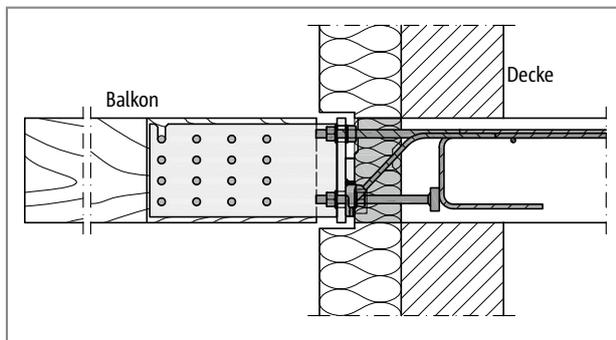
Schöck Isokorb® T Typ SK mit Stahlschwert: Anschluss an die Stahlbetondecke; Dämmkörper innerhalb der Außendämmung
